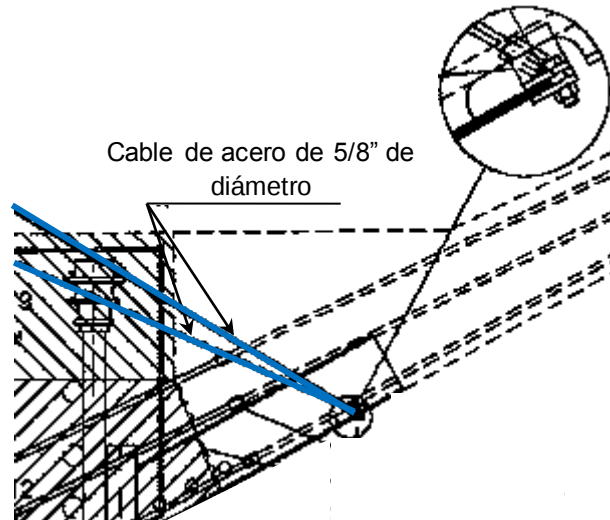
Detalle de sujeción del tirante de cable de acero de 3/8\"
